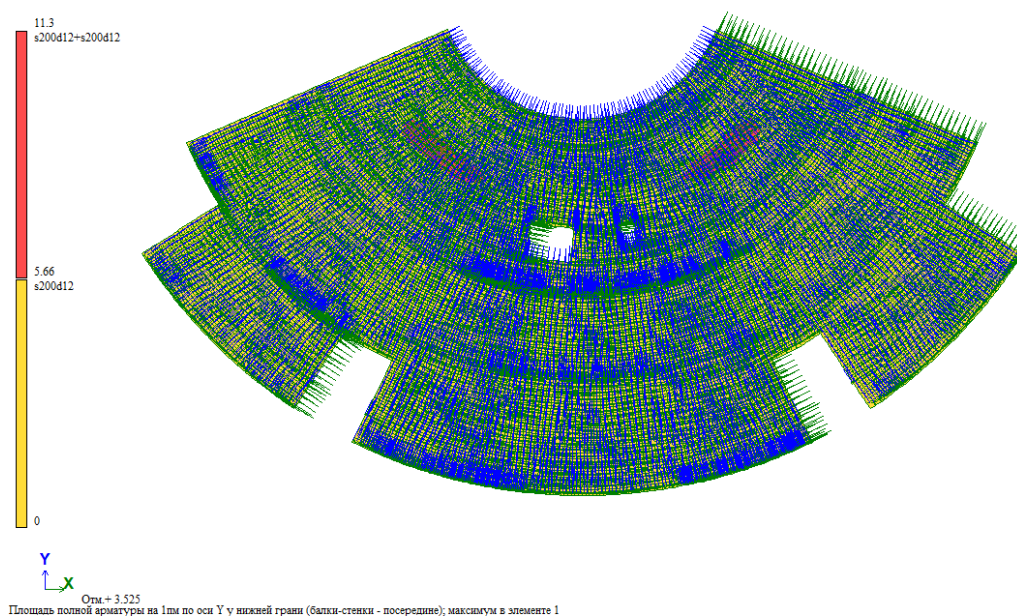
Площадь арматуры на 1м по Y у нижней грани
